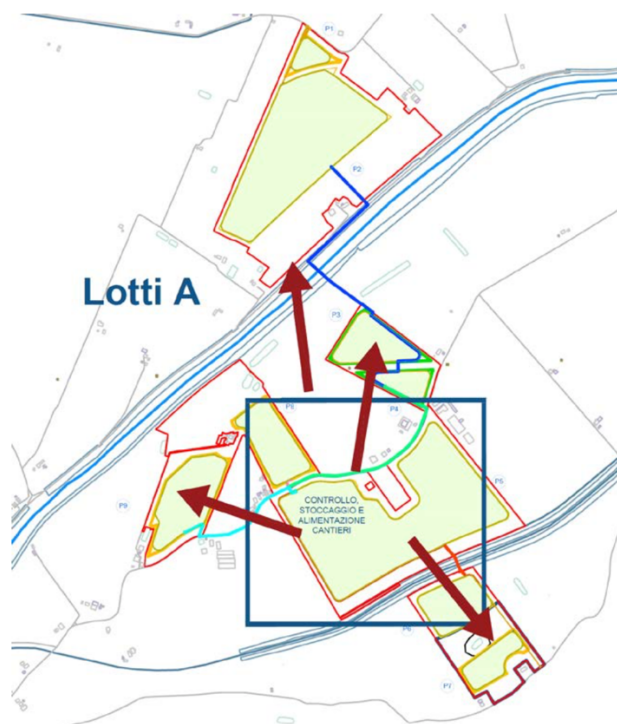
Schema generale di cantiere macro lotti A (fonte: ER_10_Piano_di_cantierizzazione)
